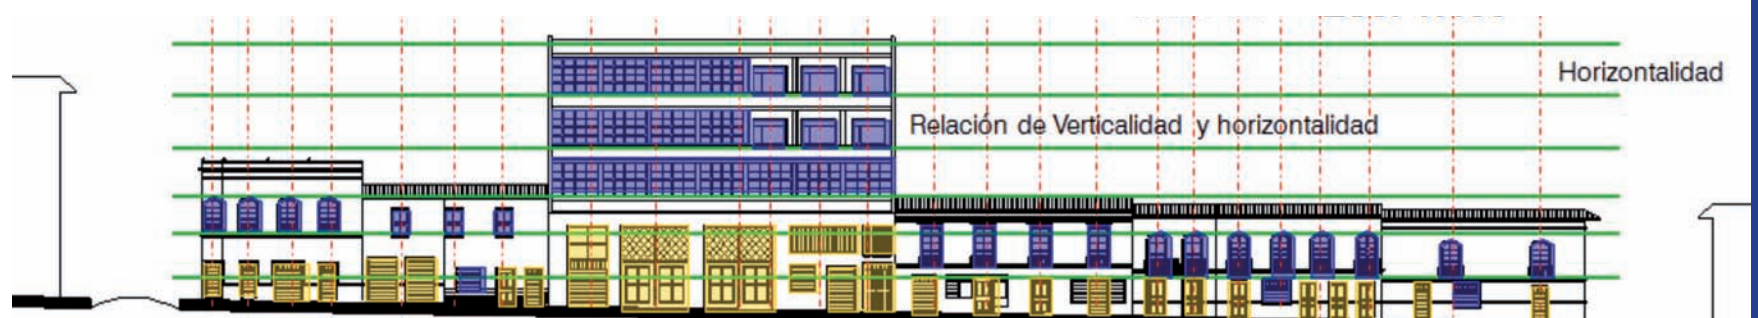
//Levantamiento de fachada, Cra 22 entre calles 19 y 20 - área de estudio//
